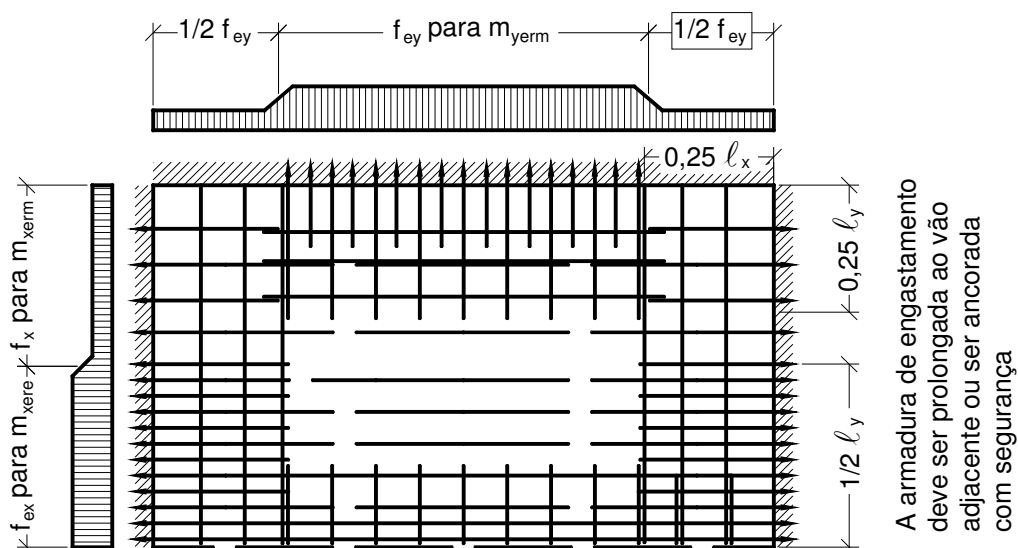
Armadura superior de laje retangular apoiada em três lados engastados com carga uniforme.
